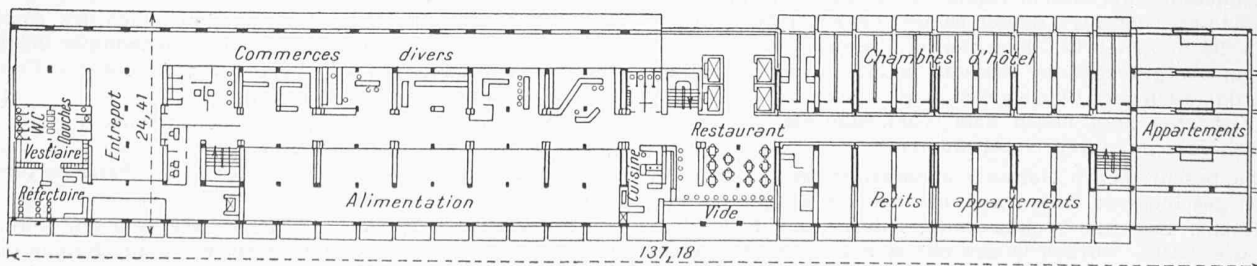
Grundriss des 8. Geschosses mit Läden, Restaurants, Hotel und Appartements, 1: 800
